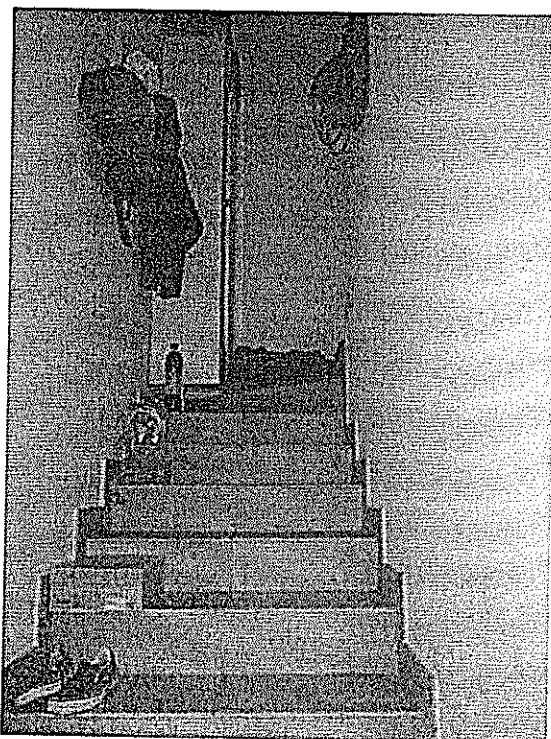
LOTTO B2: visione interna - scala accesso al piano interrato
